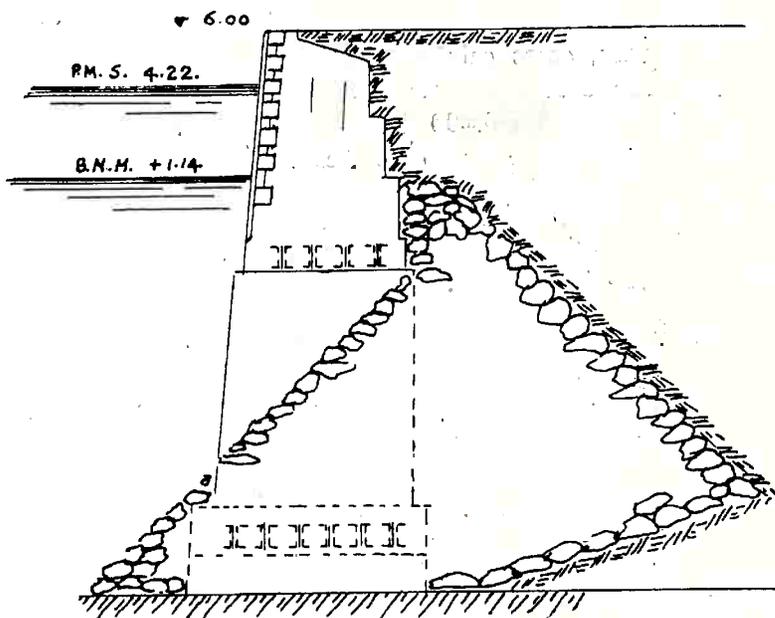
Muralhas discontinuas do porto de Lisboa.
